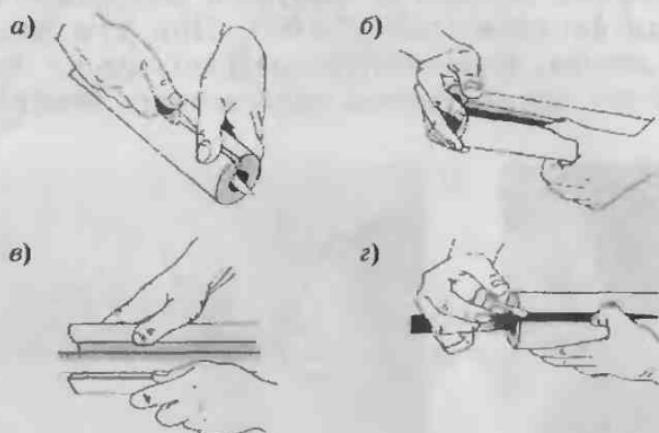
Последовательность монтажа трубчатой изоляции: а — разрезание трубки; б — раскрытие шва; в — накладывание на трубу; г — проклейка швов
